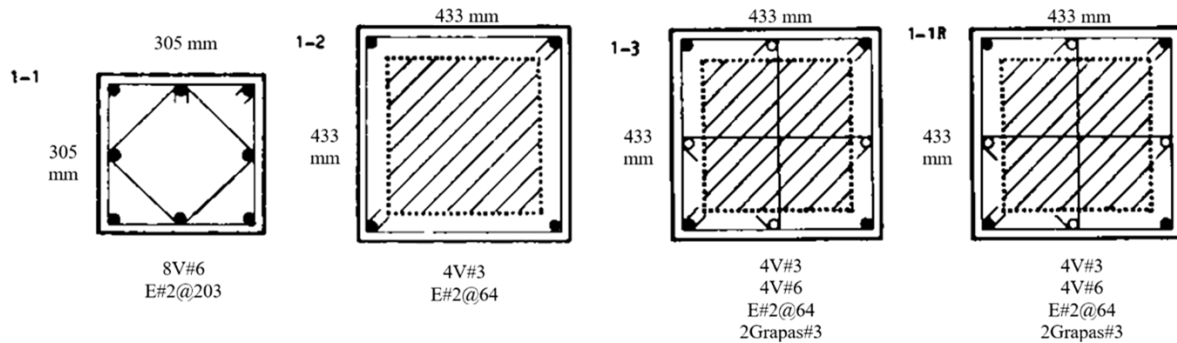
Secciones transversales de la columna original y las columnas encamisadas de Bett et al., 1998
